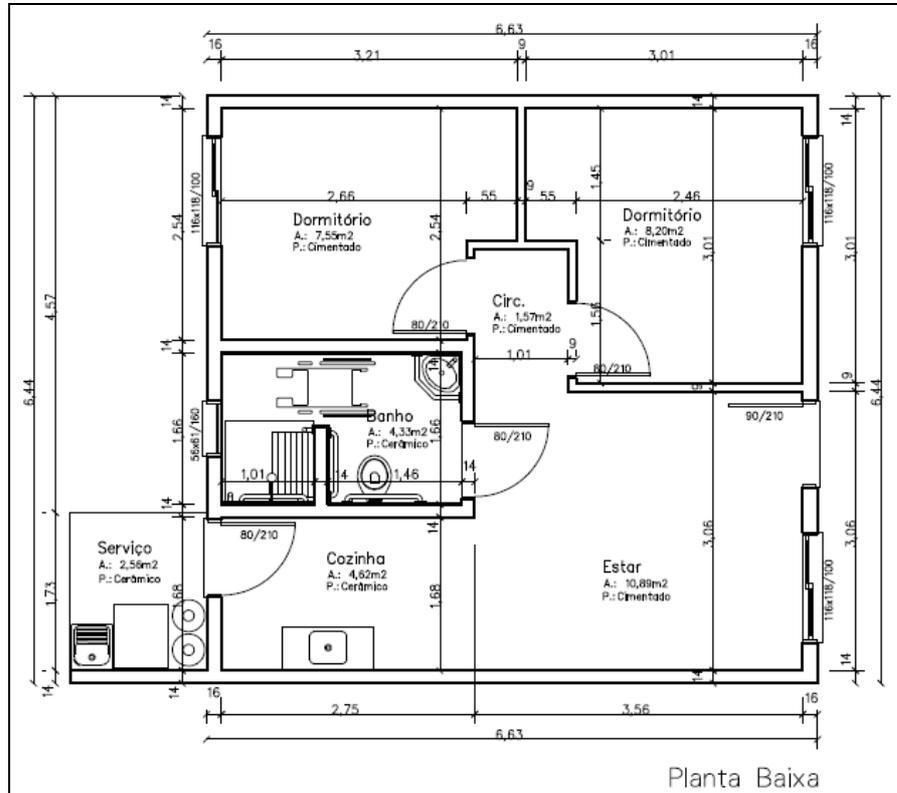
Planta baixa casa térrea – Condomínio Germano Ardoino Toniolo – 45,57m²
